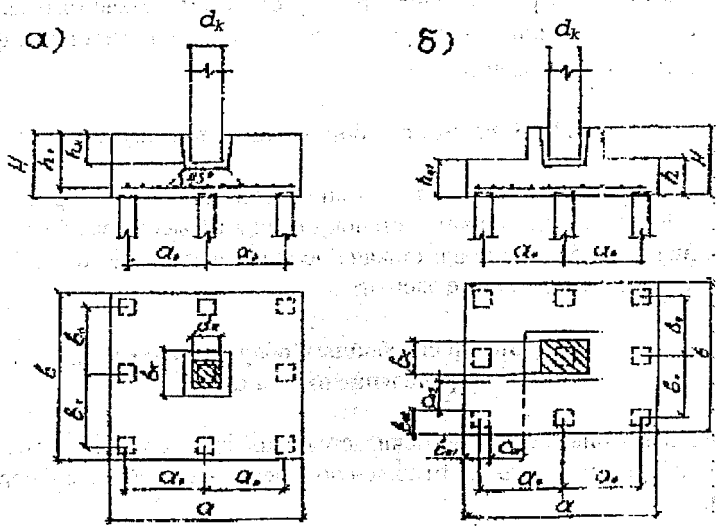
Схемы продавливания ростверка под колонной (а) и угловой свай (б)
